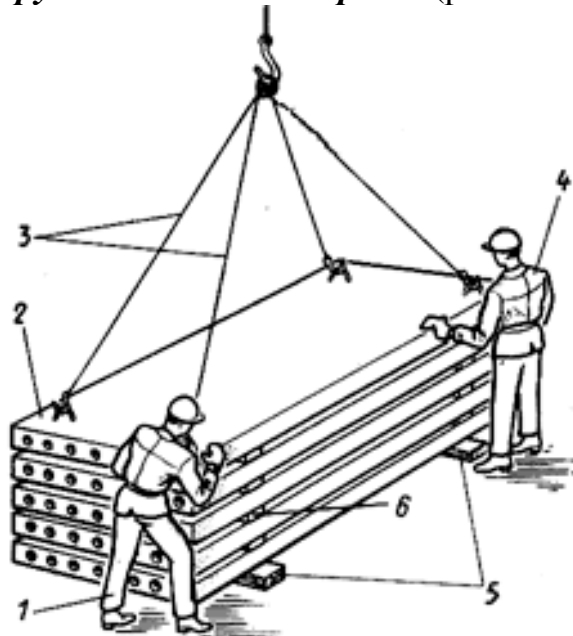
Укладання плит перекриттів у верхній ряд штабеля:
